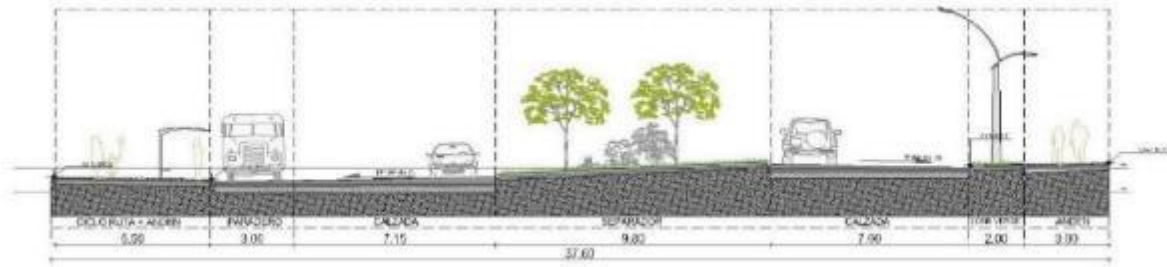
Sección vía arteria mayor. Fuente Plan vial UCO 2016.
